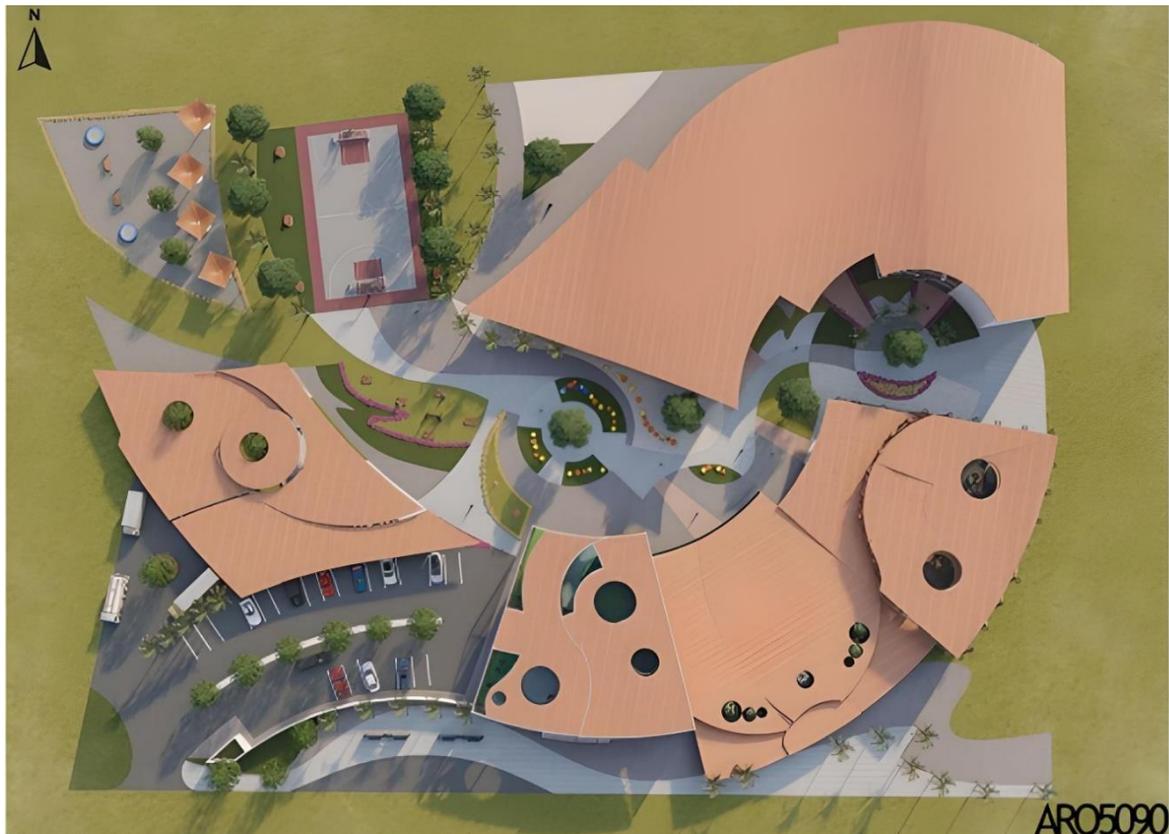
Planta de implantación. Fuente (Proyecto de grado Chilito)
